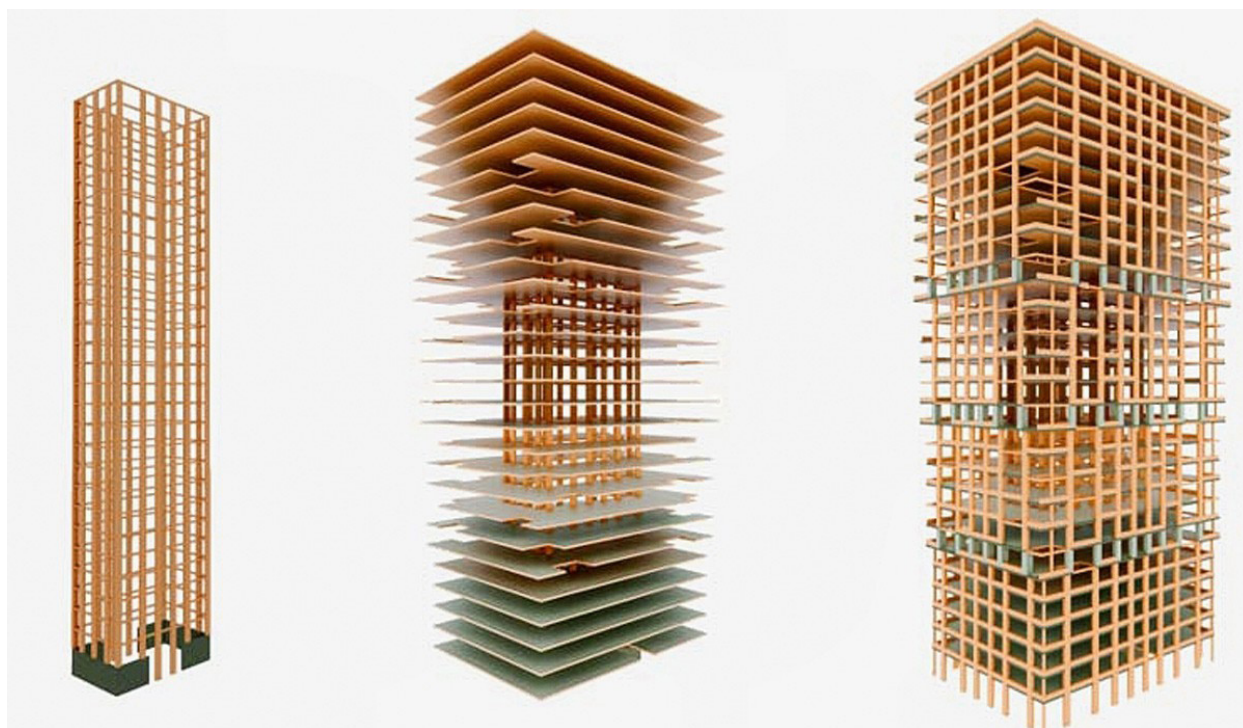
Elaborati progettuali (vista) dello studio (sx) Schmidt Hammer Lassen Architects per il progetto Rocket&Tigerli. Fonte: shl.dk
